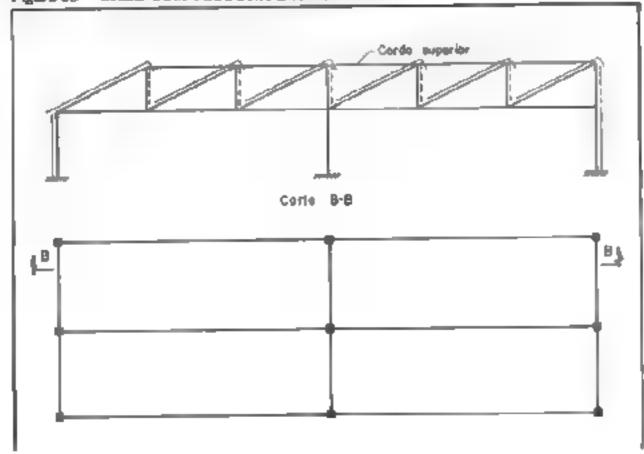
SHED SIMPLES SEM VIGA MESTRA
